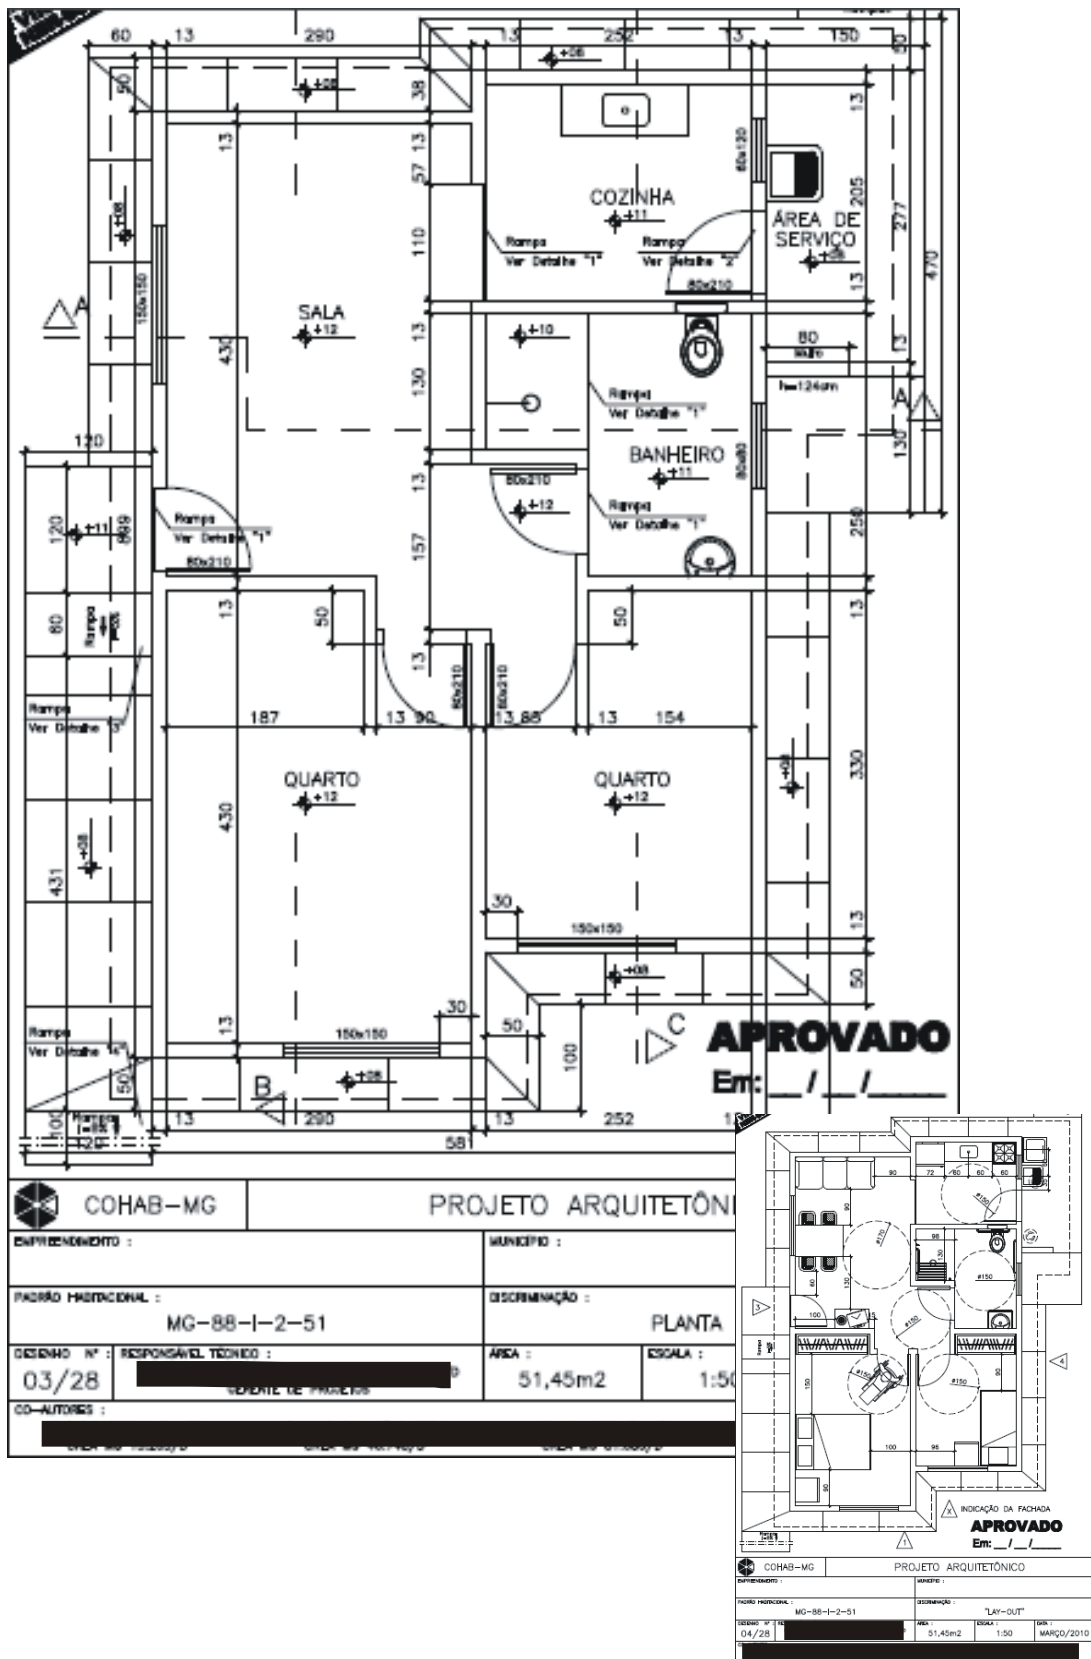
Planta baixa da casa projetada para acessibilidade cotada- padrão COHAB- MG. Em pequena escala planta baixa da casa projetada para acessibilidade com mobiliário- padrão COHAB- MG- Layout.
